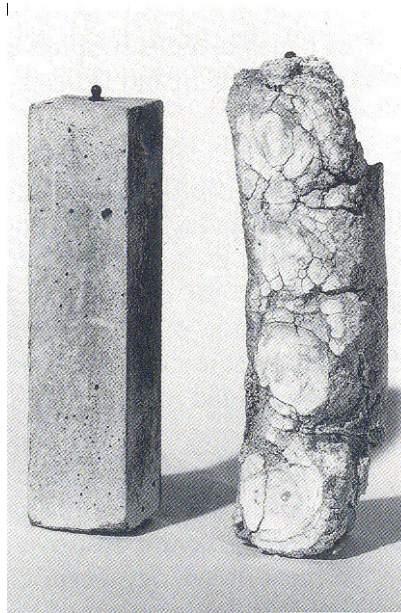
Fisuración del concreto reforzado por sulfatos, Tomado de: : Guia patologías de constructivas, estructurales y no estructurales
